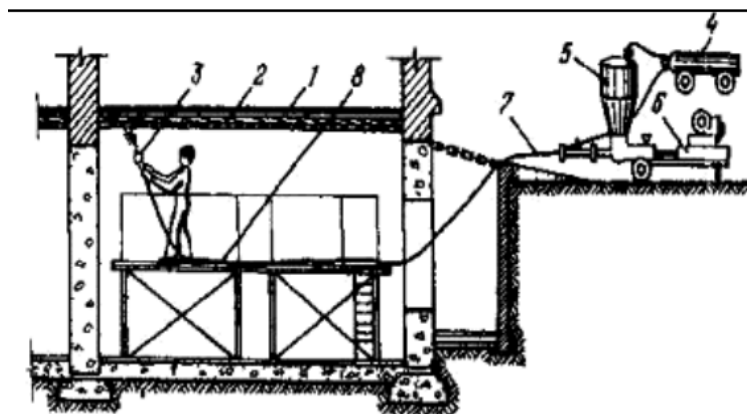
Принципиальная схема нанесения мелкозернистого бетона пневмоспособом при усилении железобетонных монолитных перекрытий: 1 – усиленная (надбетонированная) монолитная плита; 2 - бортовая опалубка; 3-сопло; 4 – передвижной компрессор; 5 - загрузочный бункер; 6 - питатель на базе растворонасоса С-251; 7 - гибкий шланг; 8 - инвентарные подмости
